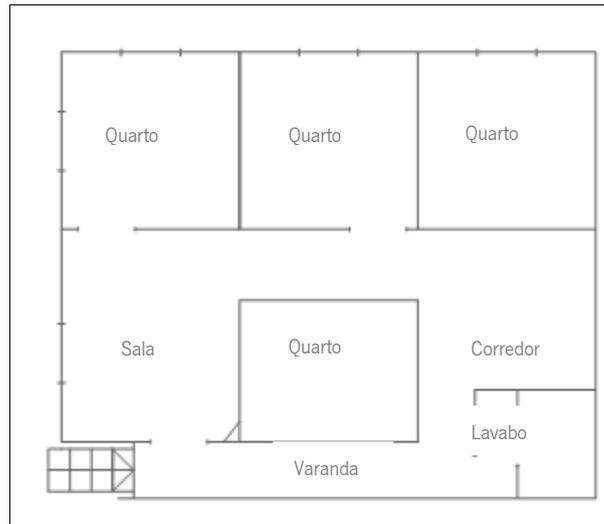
Planta de Palheiro original, Esmoriz. Escala 1:100
